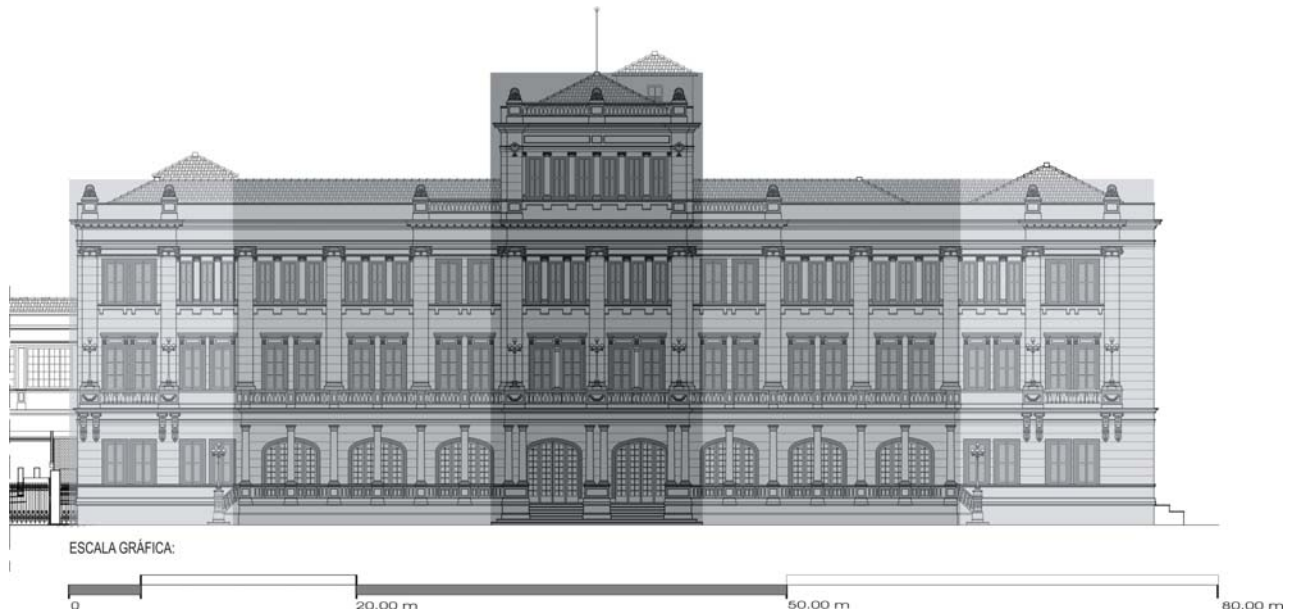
Relação Planta-Fachada – simetria fachada.
